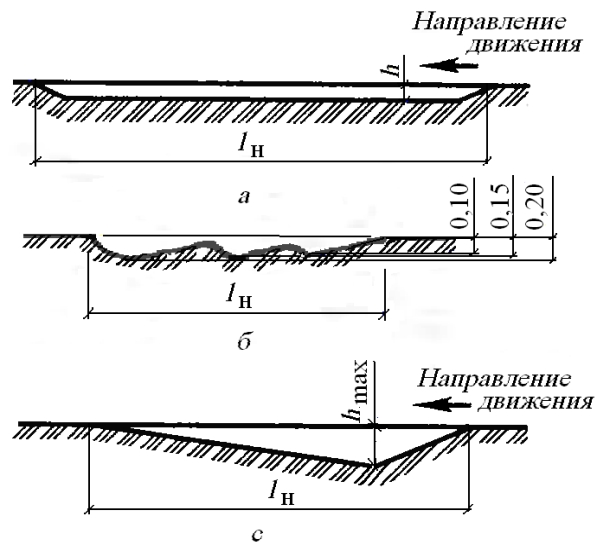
Схемы резания грунта бульдозером: *a* – прямоугольная; *б* – гребенчатая; *с* – клиновая
